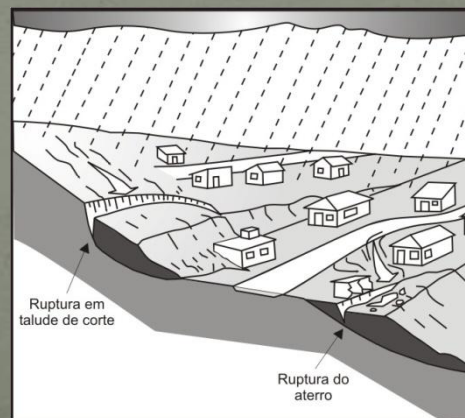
Perfil esquemático do escorregamento Induzido. Cd.apoio.
